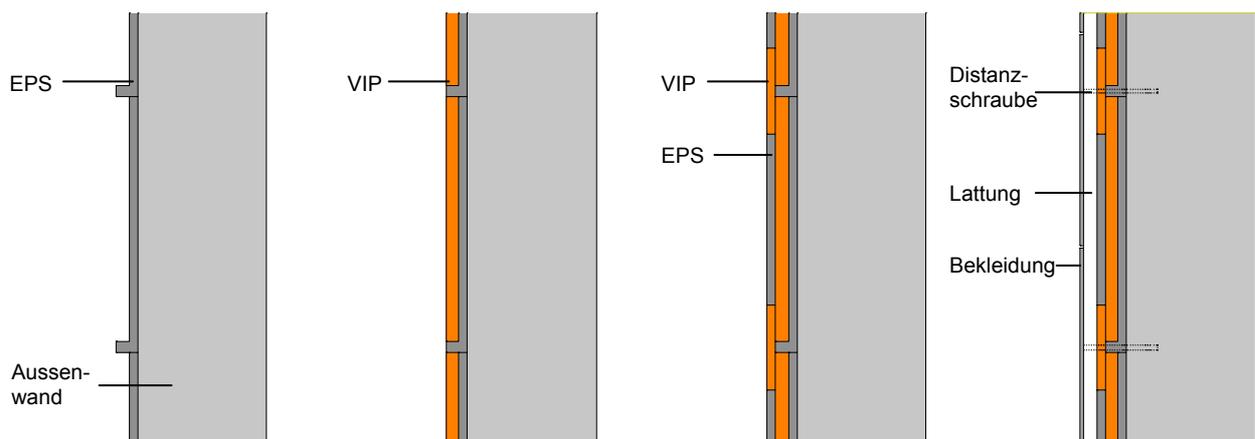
Konstruktionsvariante mit VIP-Abdeckung der EPS-Horizontalfuge. Montageschritte im Vertikalschnitt.
